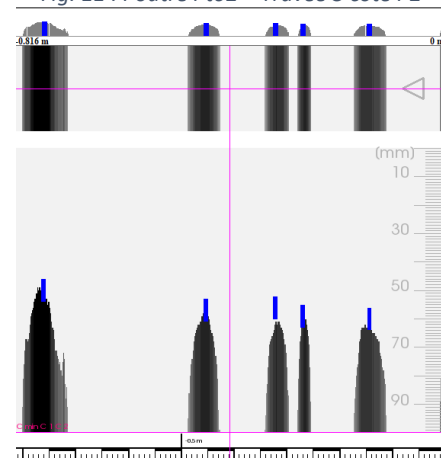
Poutre Pt05 – Travée 3 à mi-travée
